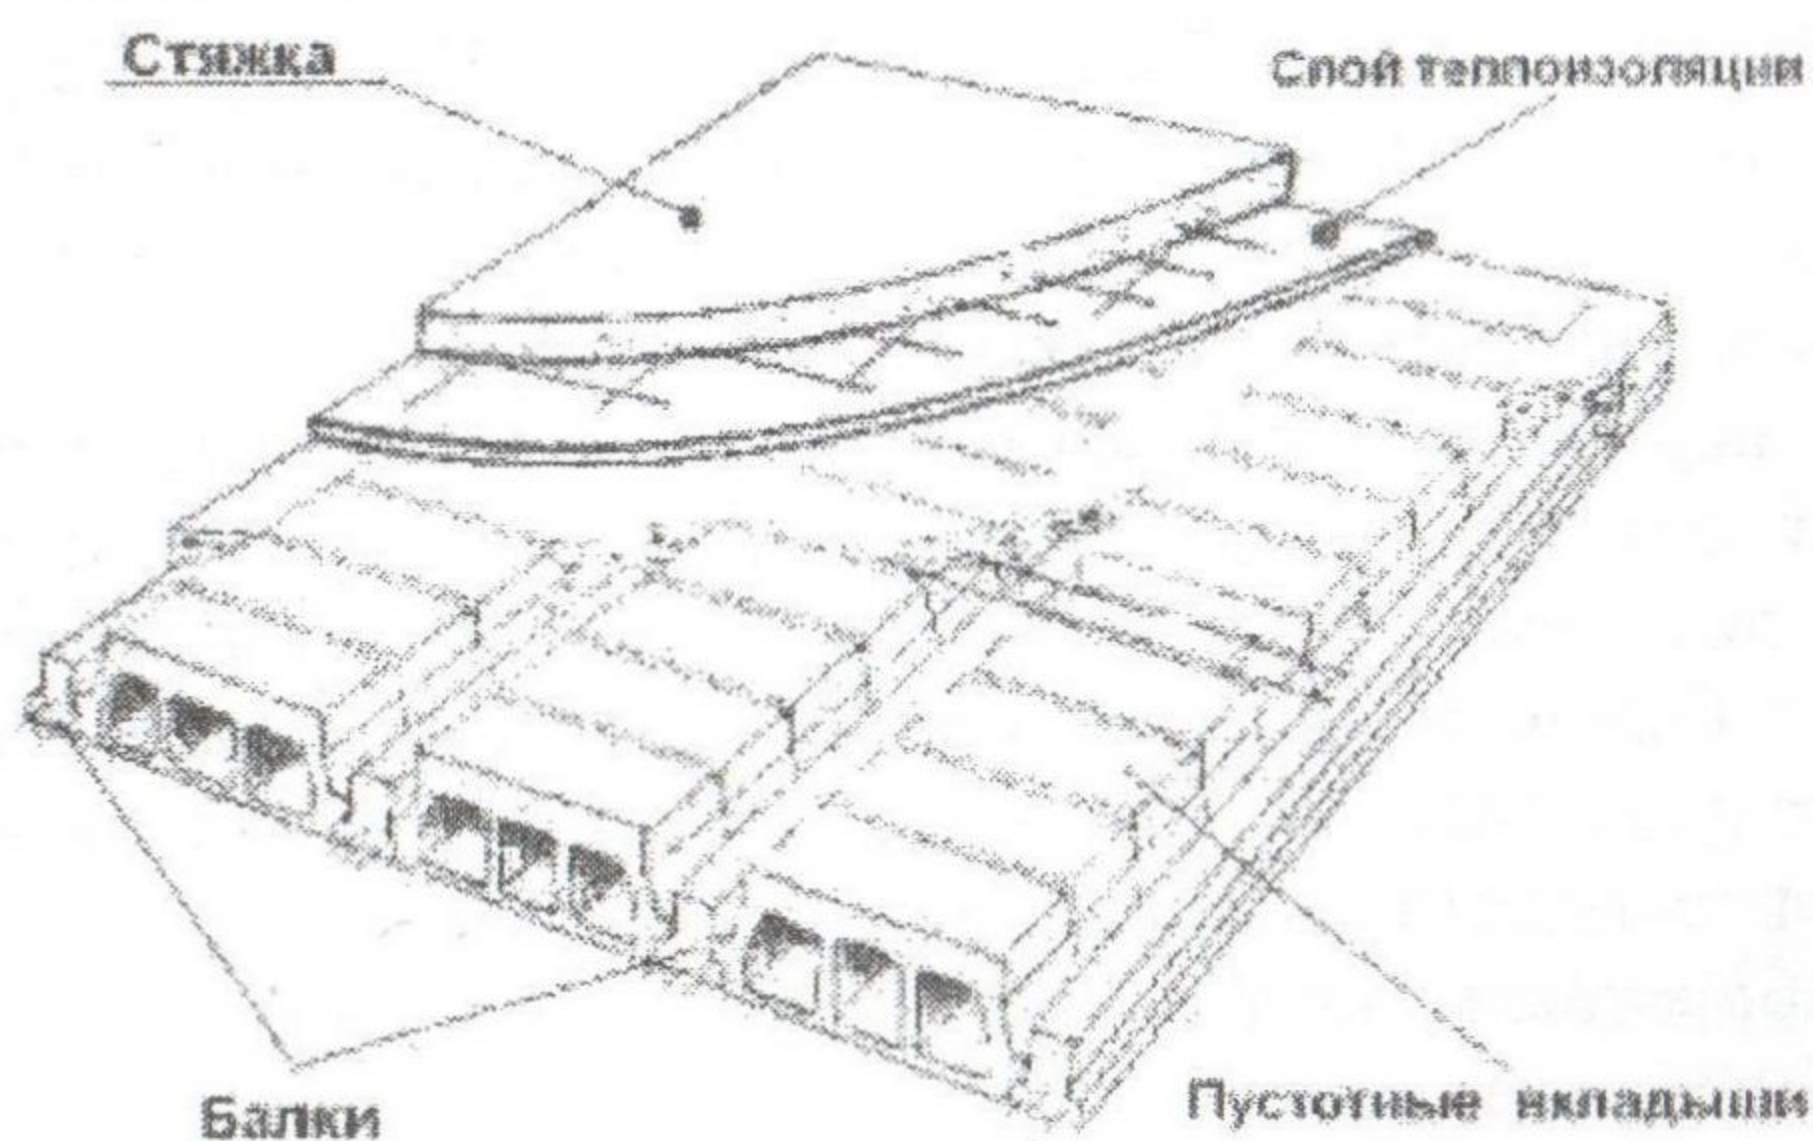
Сборные железобетонные перекрытия с пустотными вкладышами.
